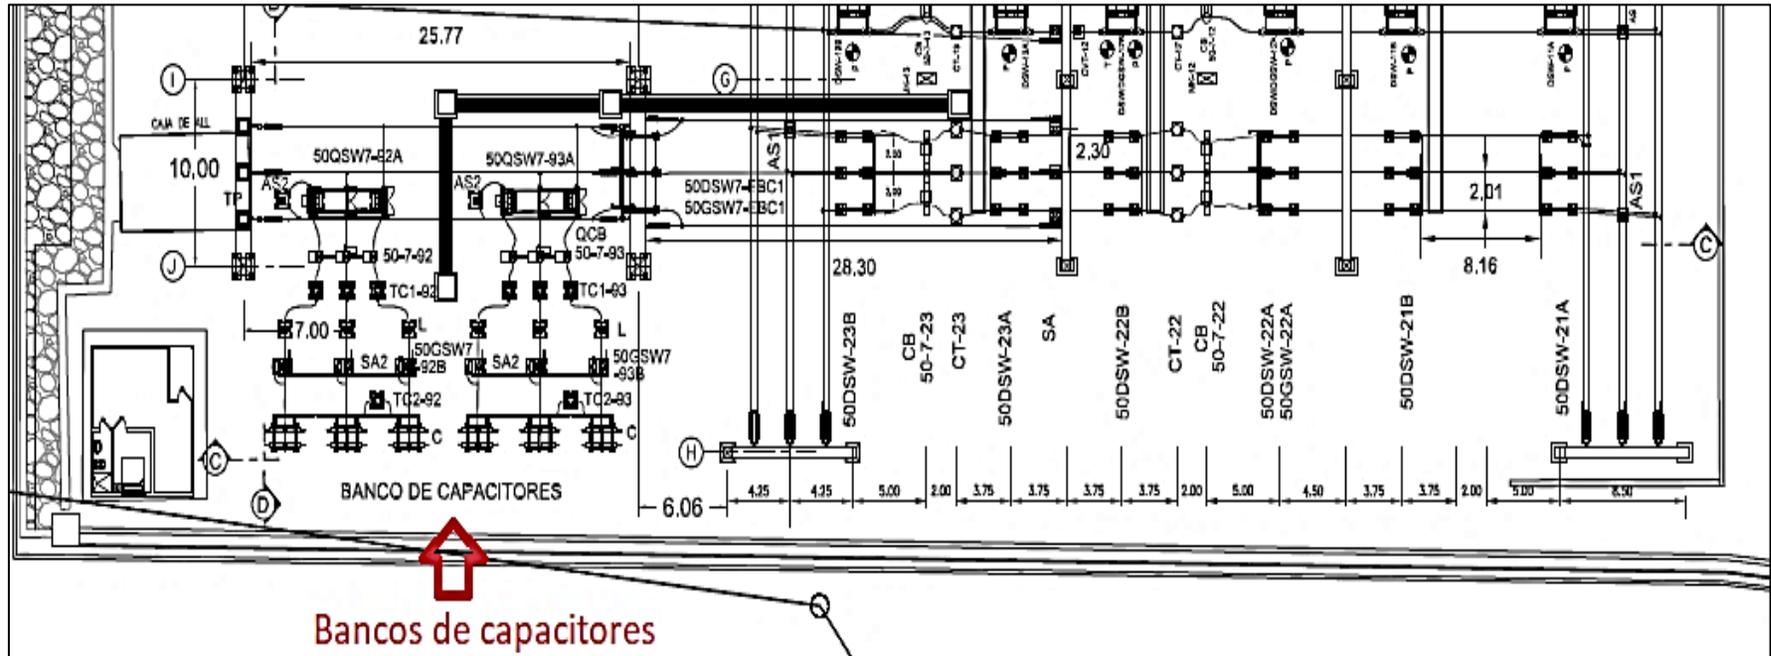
Vista en Planta “Instalación de 2 Bancos de Capacitores en la Subestación San Matías”
